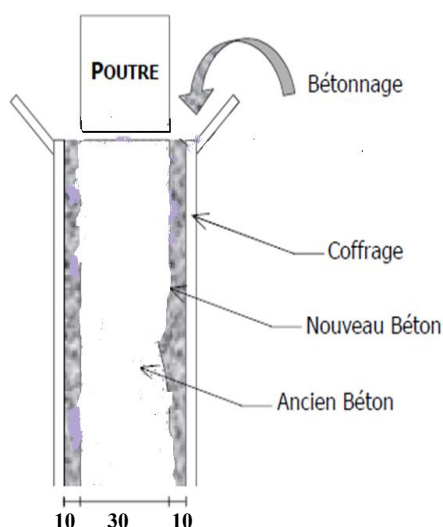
Coffrage amarce poteaux et coulage de nouveau béton
